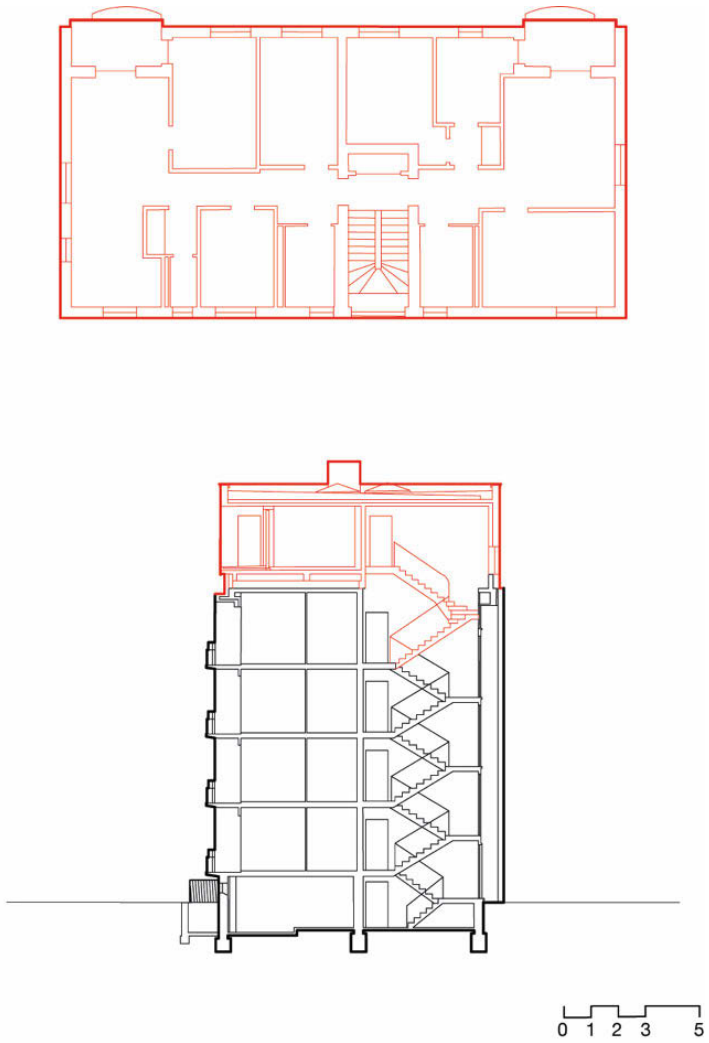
Grundriss & Schnitt Aufstockung, Fritz-Kissel-Siedlung
